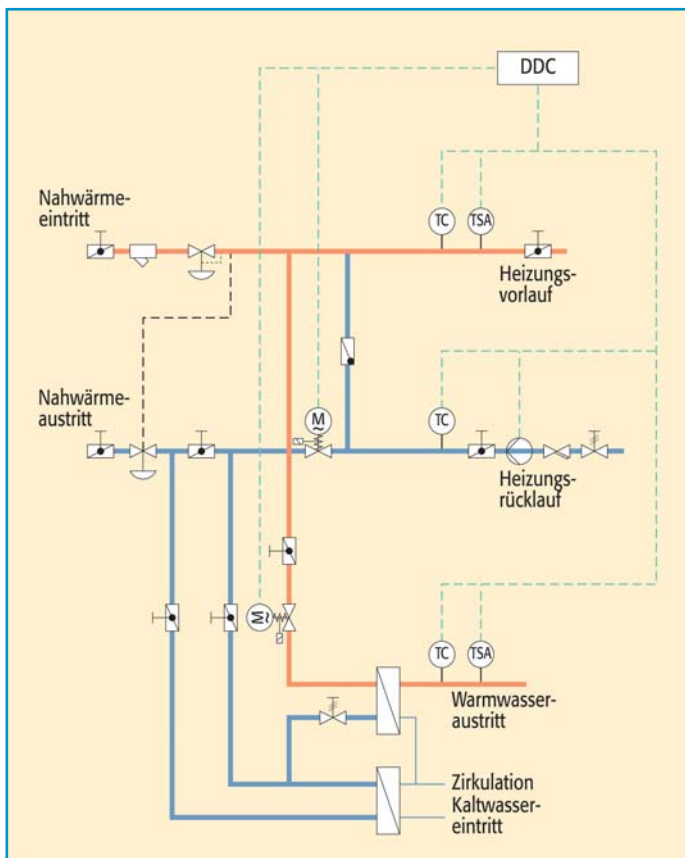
Ursprünglich Planung der Hausanschlussstationen.
